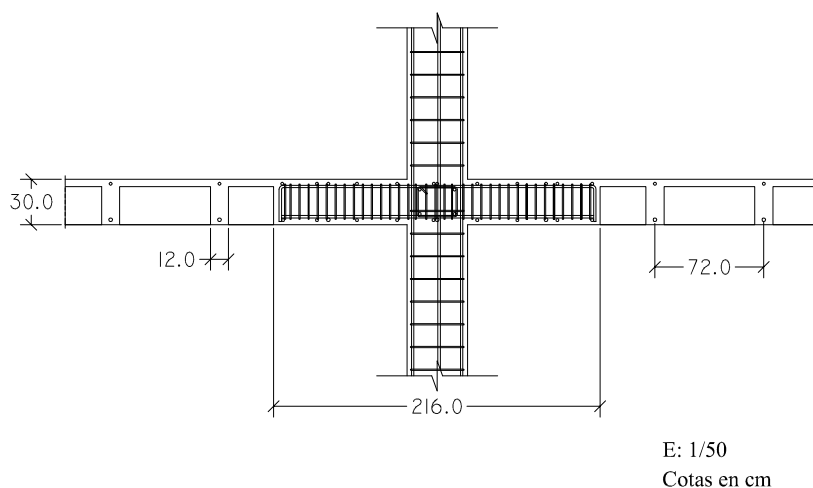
Geometría de forjado reticular: Sección conexión pilar-ábaco interior
